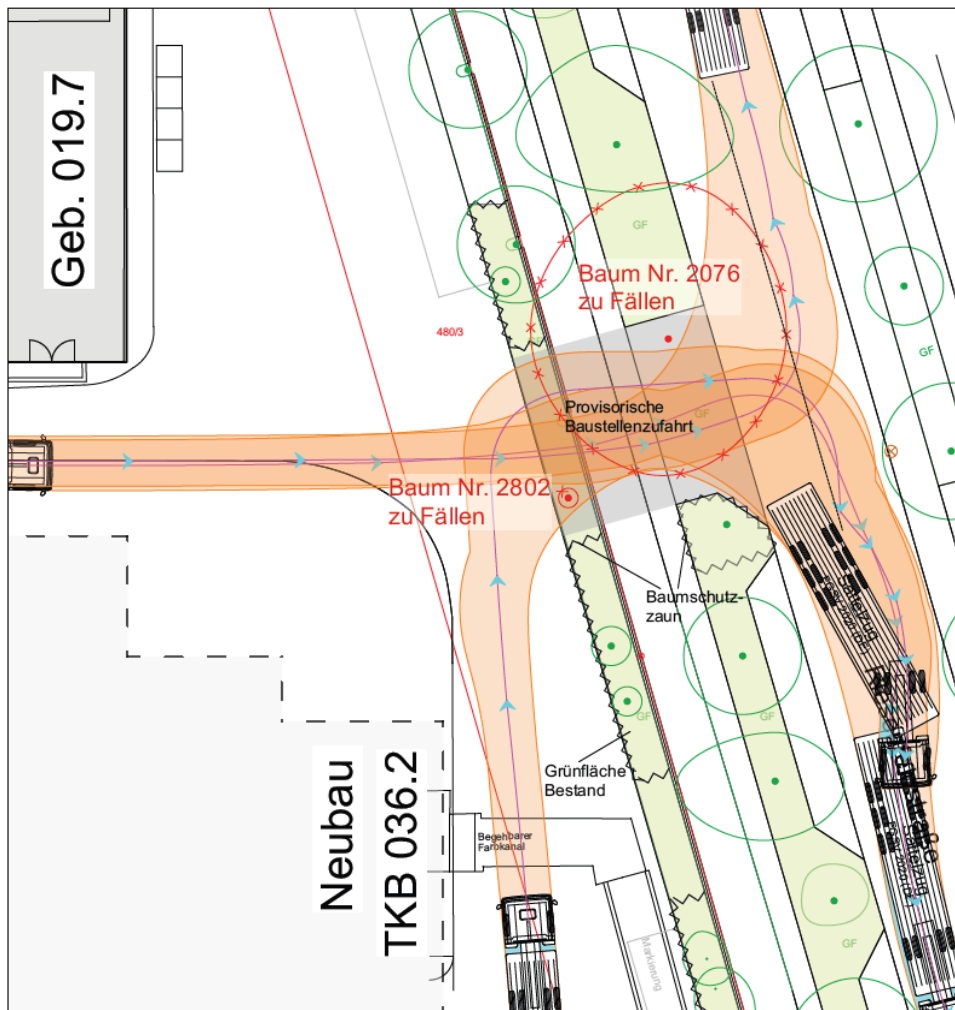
Übersichtsplan Lage Baustellenzufahrt o.M.
